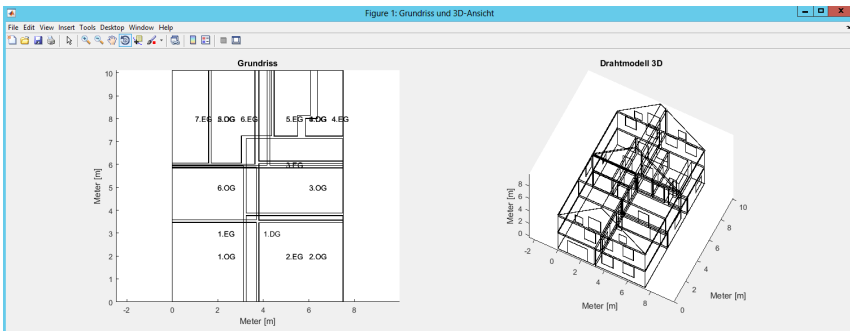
Grundriss und 3D-Drahtmodell in ResourceApp (gesamtes Gebäude)
